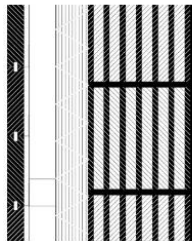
Secciones constructivas de fachada. Elaboración del autor.
